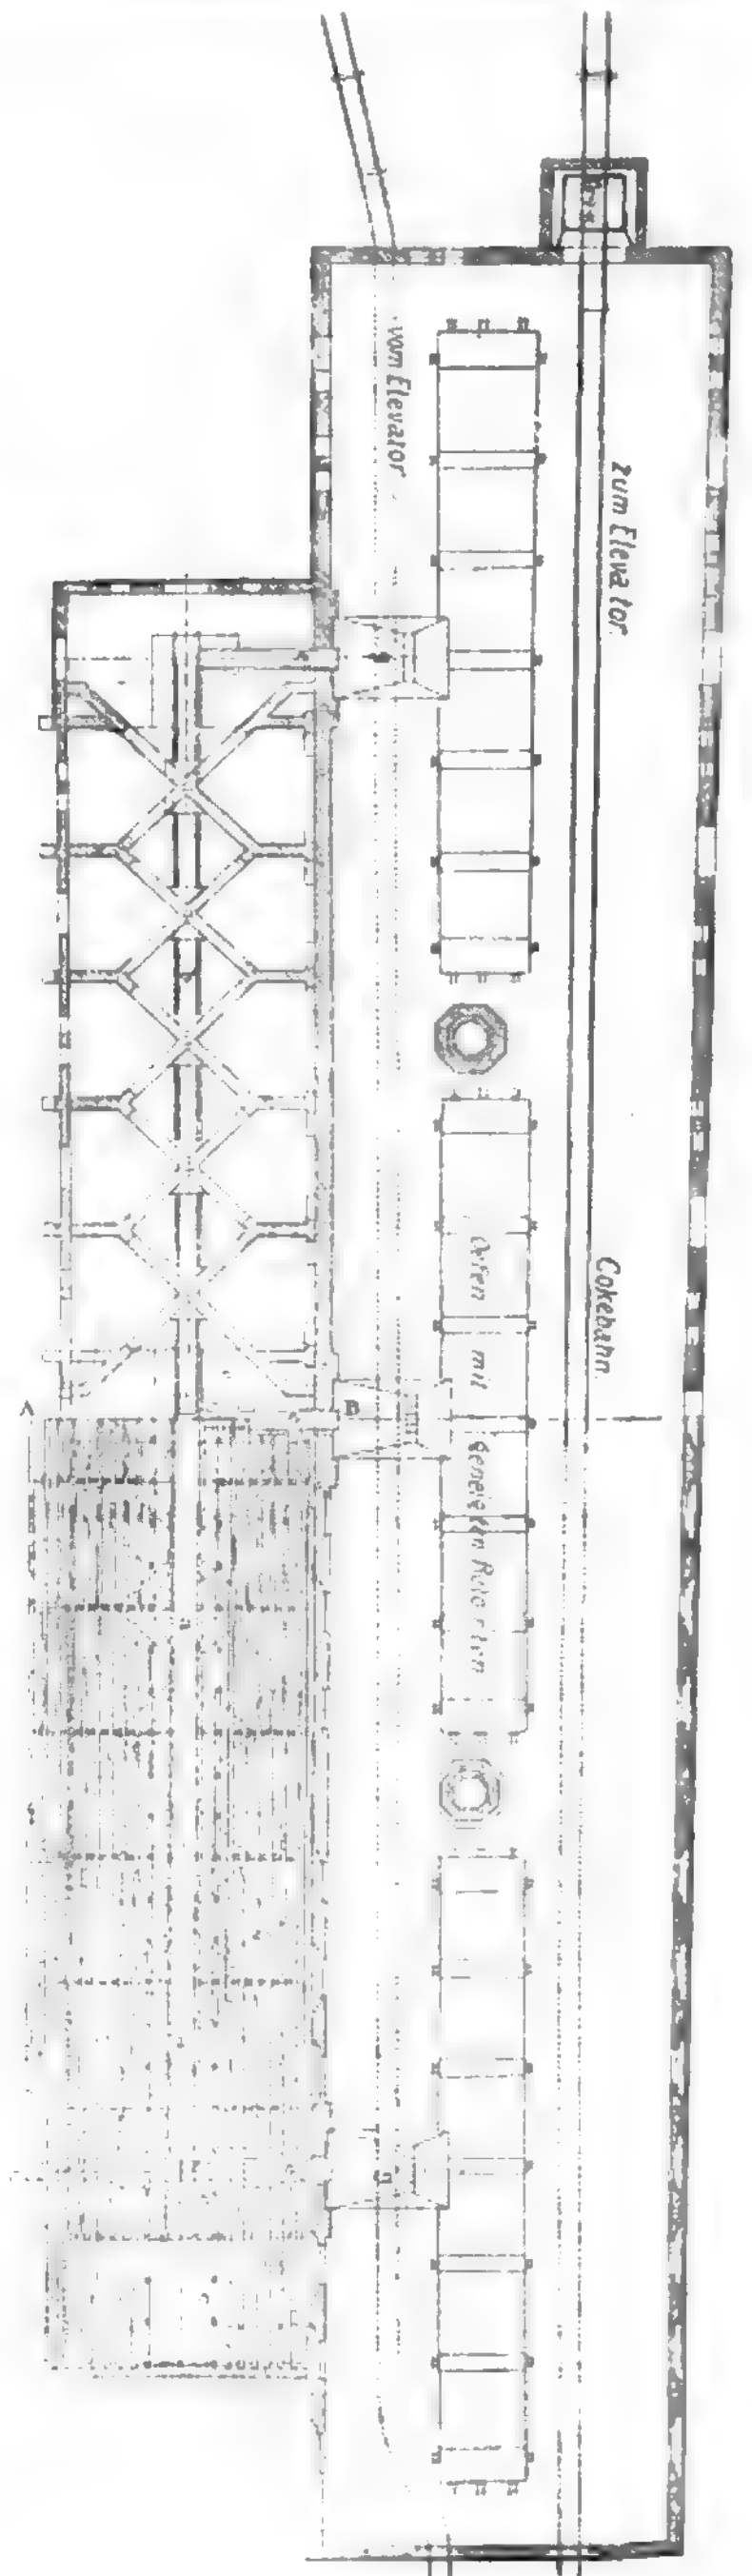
Grundriß des Kohlenmagazins auf dem Querschnitt und des Hofes daneben.
